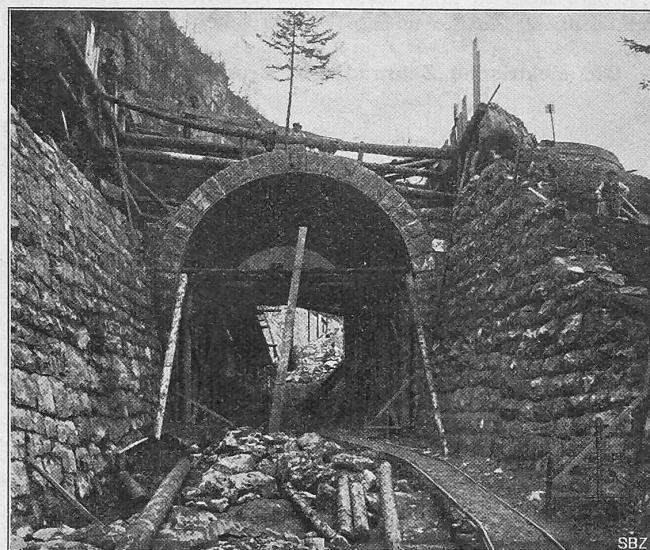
Gewölbte Strassen-Ueberführung im Bau.
